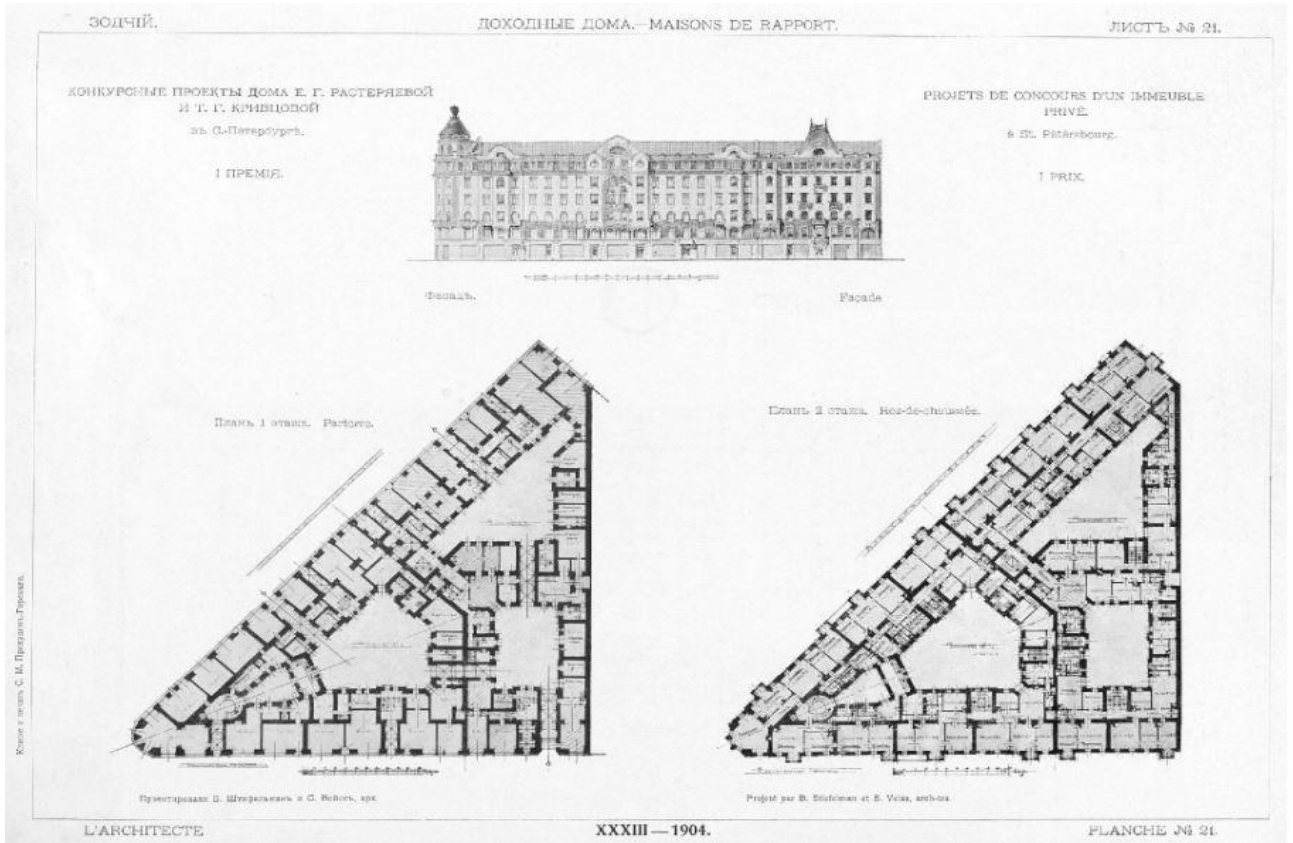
Конкурсный проект доходного дома Е. Г. Растеряевой и Т. Г. Кривцовой в Санкт-Петербурге, эскиз фасада, план 1 этажа, план 2 этажа. Зодчий №21.
